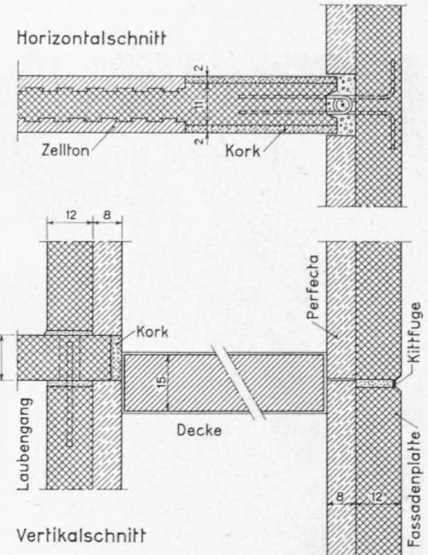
Verbindungen, Isolation. *Oberer Bildteil:* Grundriss. Zusammenschluss der Fassadenplatte mit einem Innenwandelement. Auf 50 cm Tiefe ein 2 cm starker Korkstreifen (anstelle der Tonplatten). Zusammen mit den Perfectaplaten der Aussenwände ergibt sich eine kontinuierliche Isolationsschicht (ohne Kältebrücken bei der Schlaufenverbindung). *Der untere Bildteil* zeigt im Vertikalschnitt die Uebergänge von der Innendecke einerseits zur Fassadenwand, andererseits zu Laubengangwand mit Balkonplatte. Die Isolationsschicht der Aussenwände ist durchgezogen.
